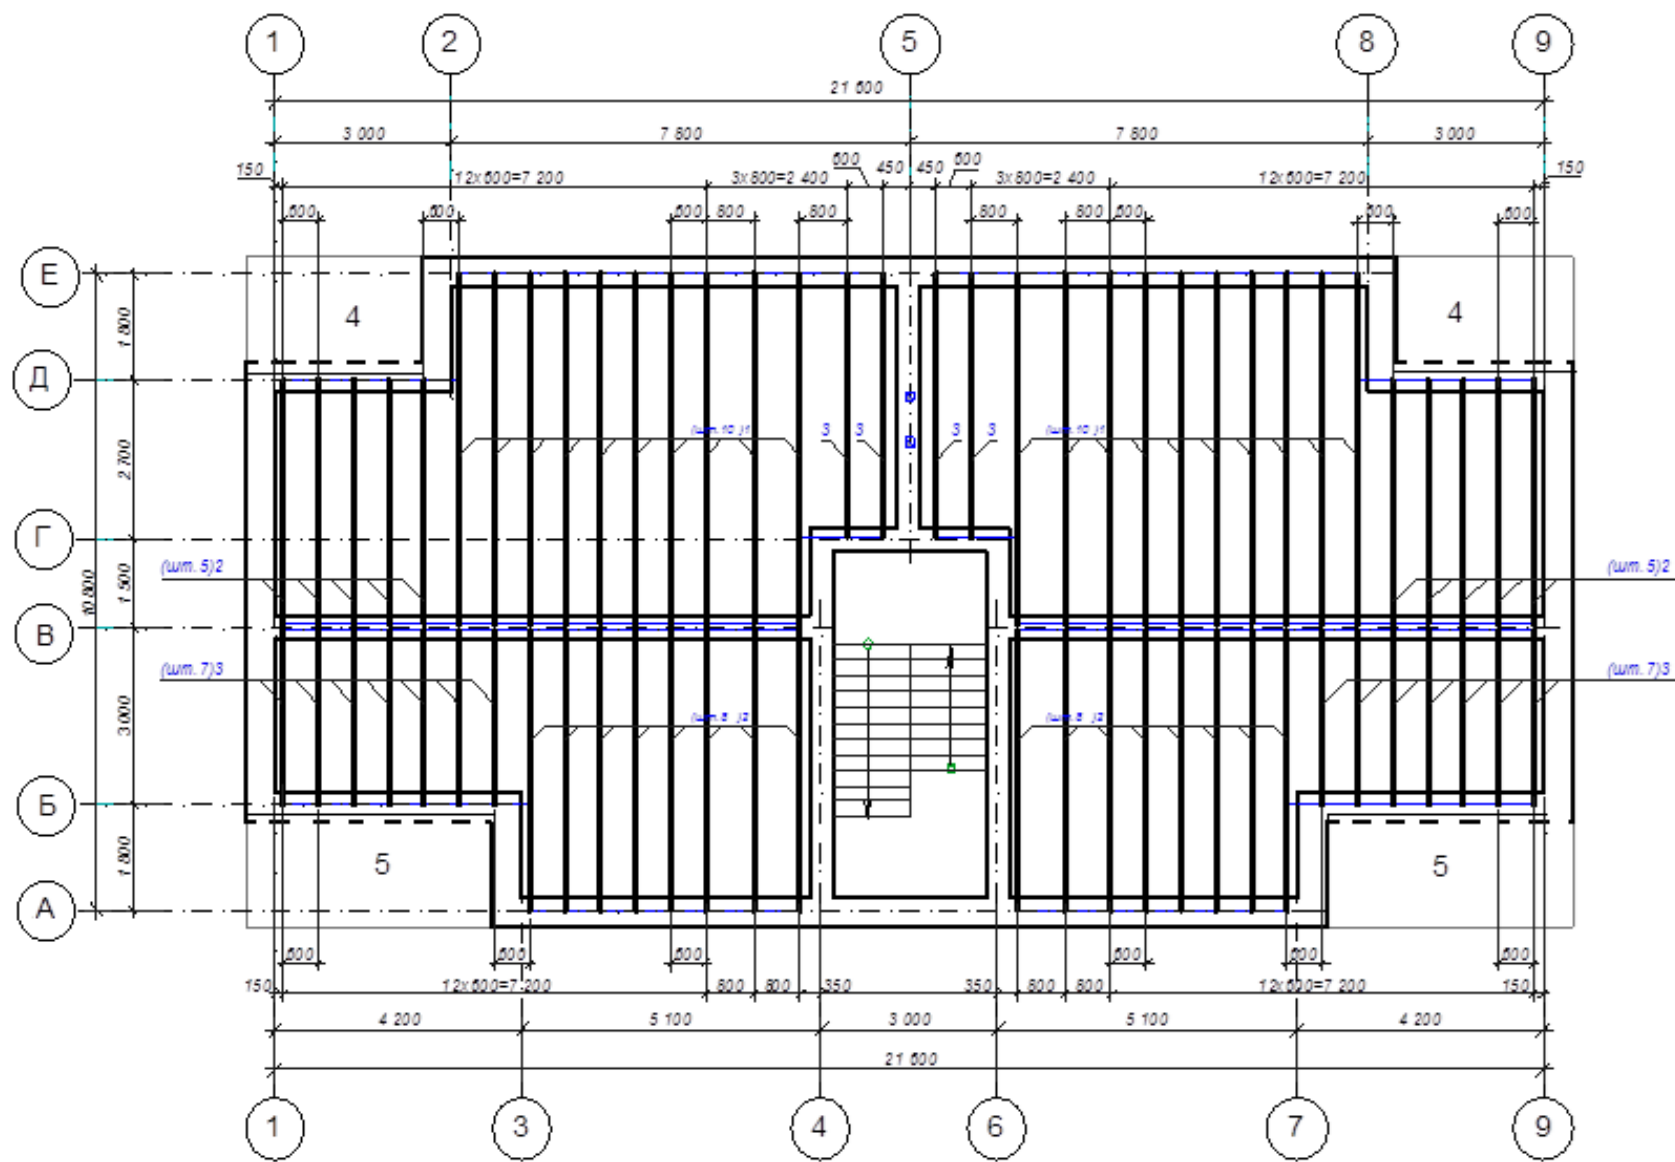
Пример оформления схемы расположения элементов балочного перекрытия
